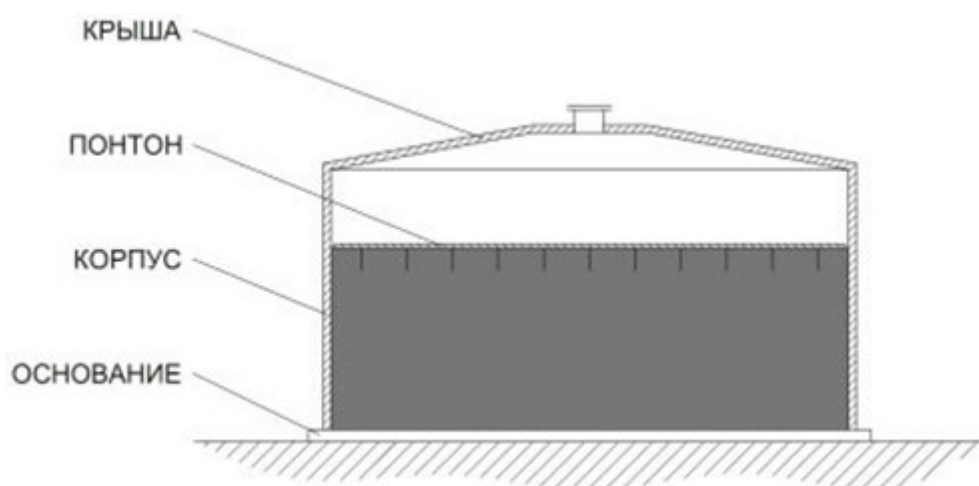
Цилиндрический резервуар со стационарной крышей и понтоном
